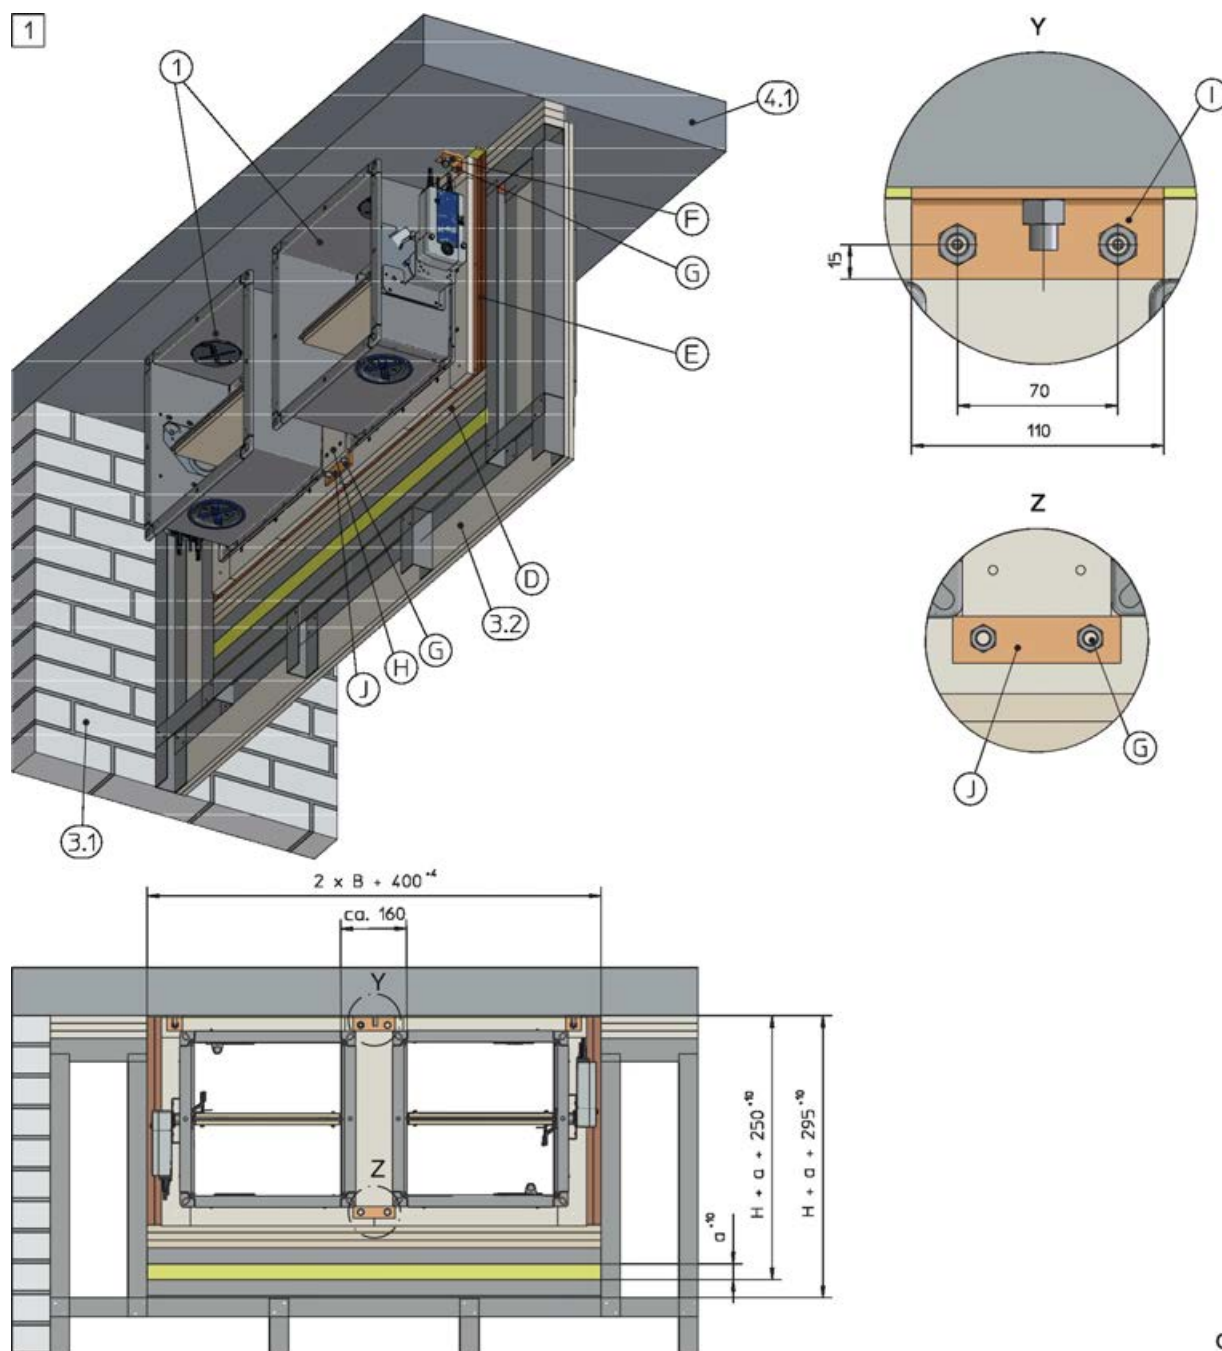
Installazione a secco in una parete divisoria leggera con collegamento flessibile al soffitto e kit d'installazione GL..., installazione di due serrande tagliafuoco FK2-EU fianco a fianco in aperture di installazione separate
